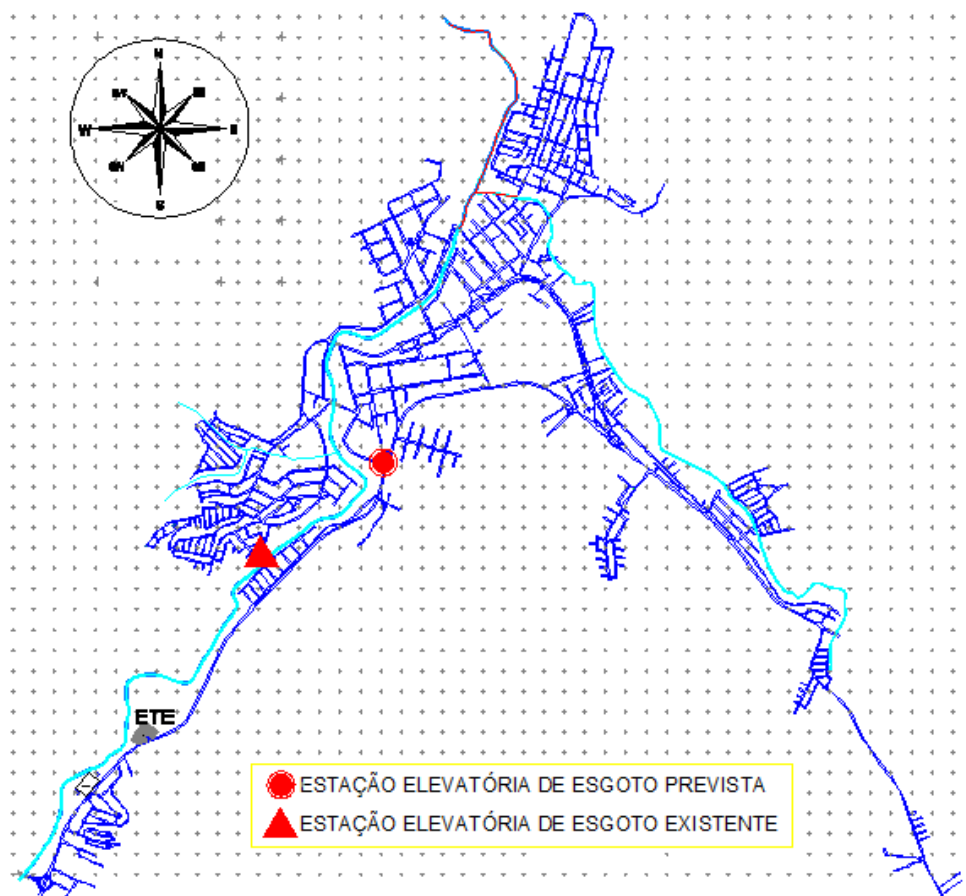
Localização da Elevatória de Esgoto Bruto prevista e da Elevatória de Esgoto Bruto Existente.
